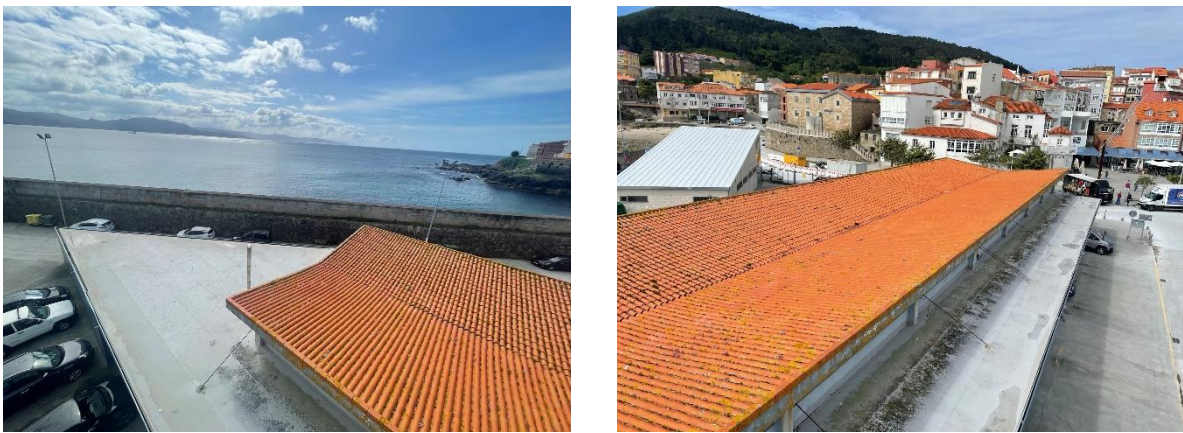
Vista general de la cubierta. Extremo este (izda.) y extremo oeste (dcha.)
